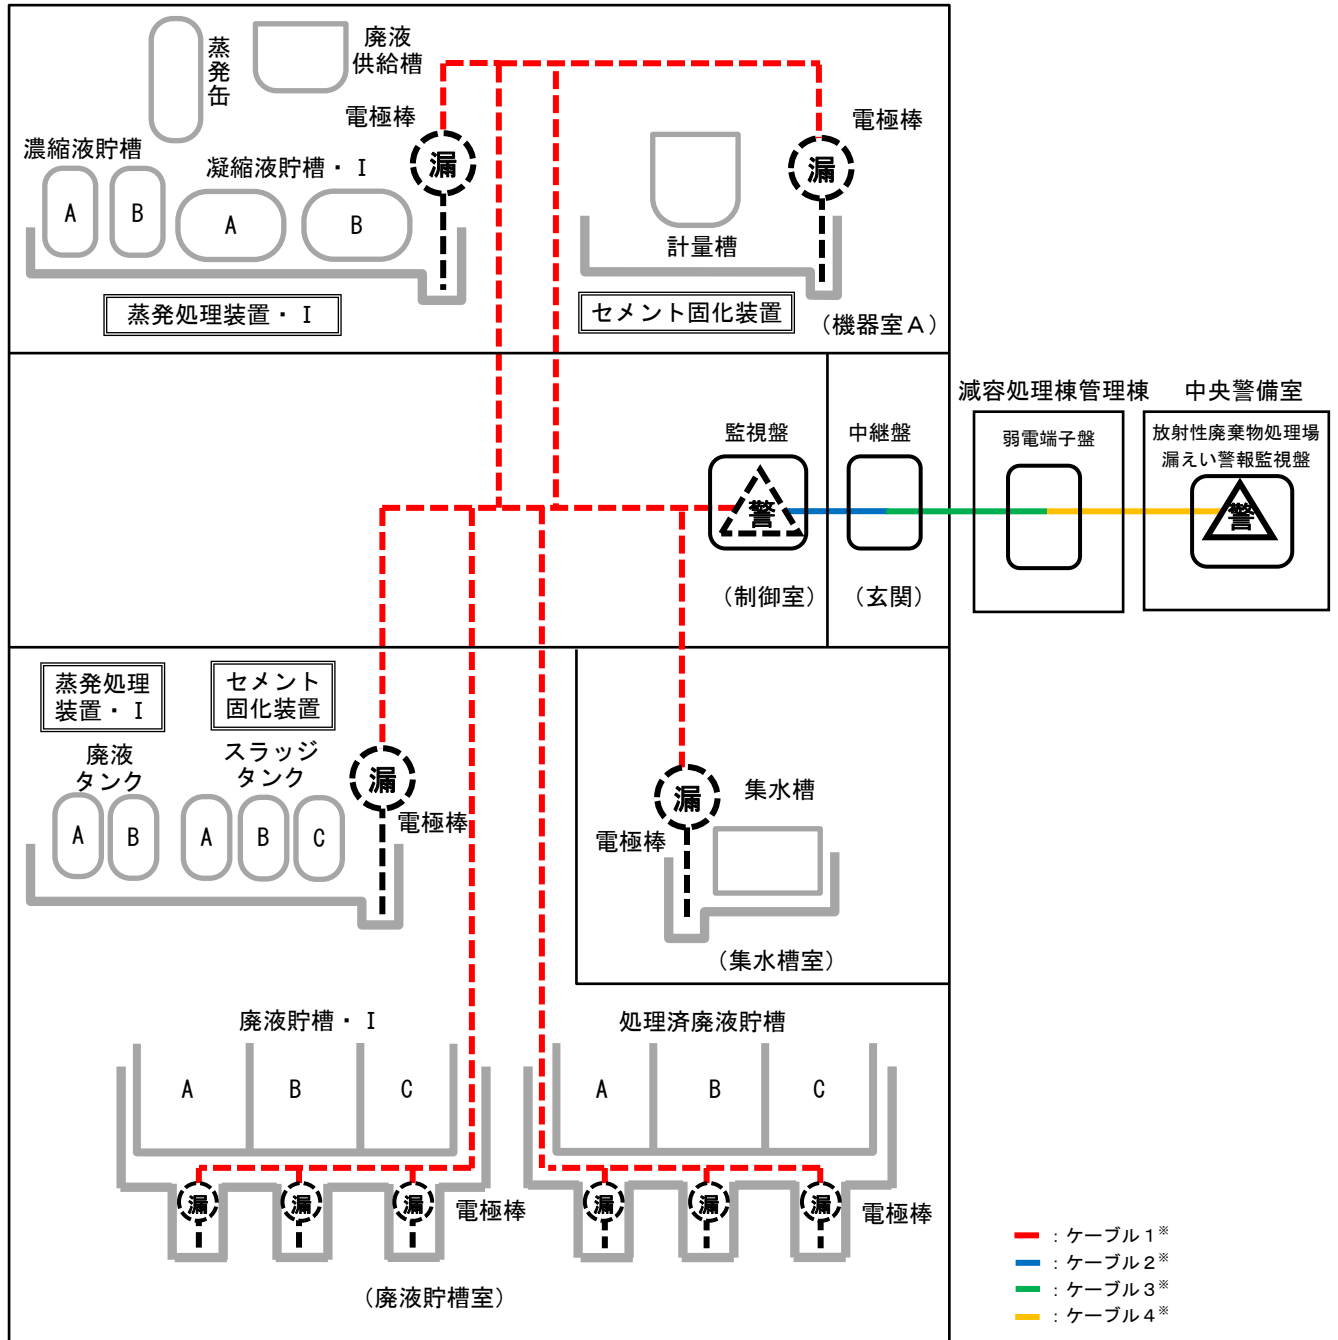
(1/2) 第2廃棄物処理棟の電極棒の配置図
